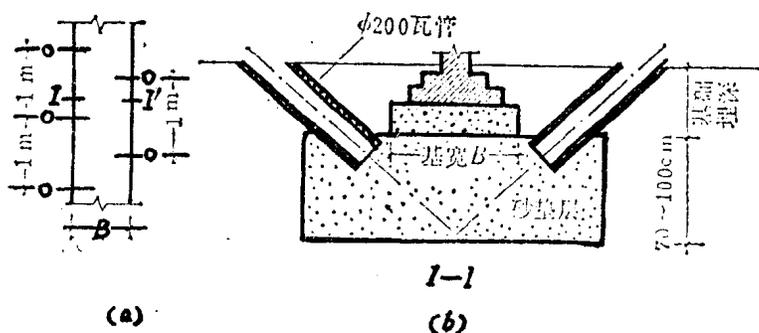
抽砂纠倾法抽砂孔平面布置与剖面图
